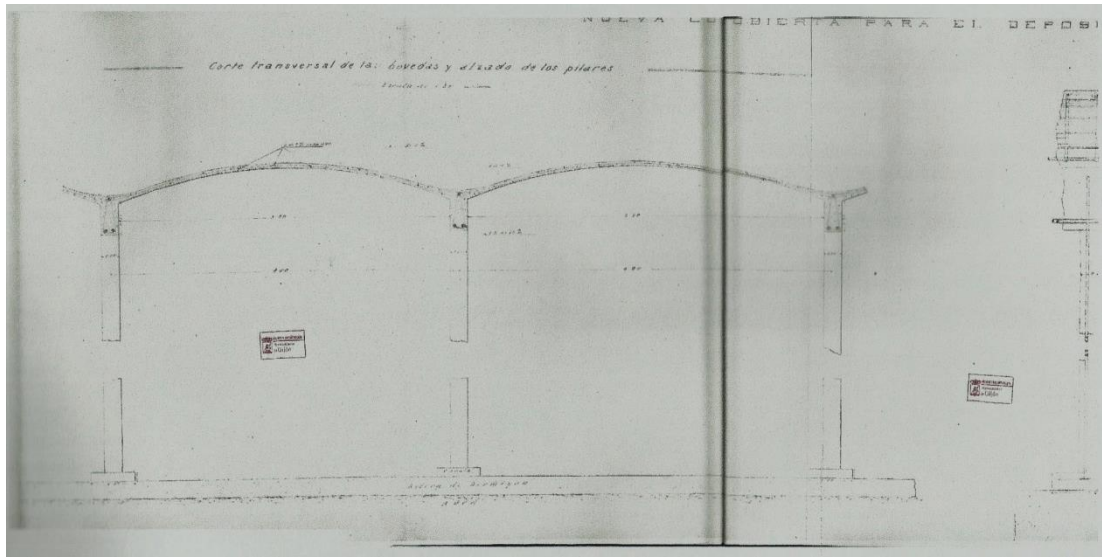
Nueva cubierta para el depósito de Gijón. Bóvedas rebajadas y apoyos.1903. Archivo Municipal de Gijón. Expediente No.132
